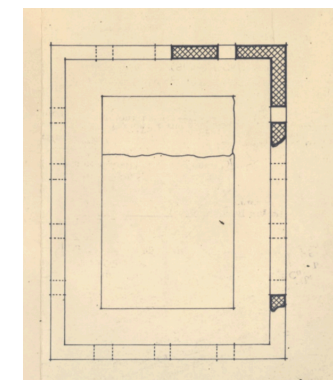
Planta de cubierta donde se especifica con un sombreado el almenado existente.
